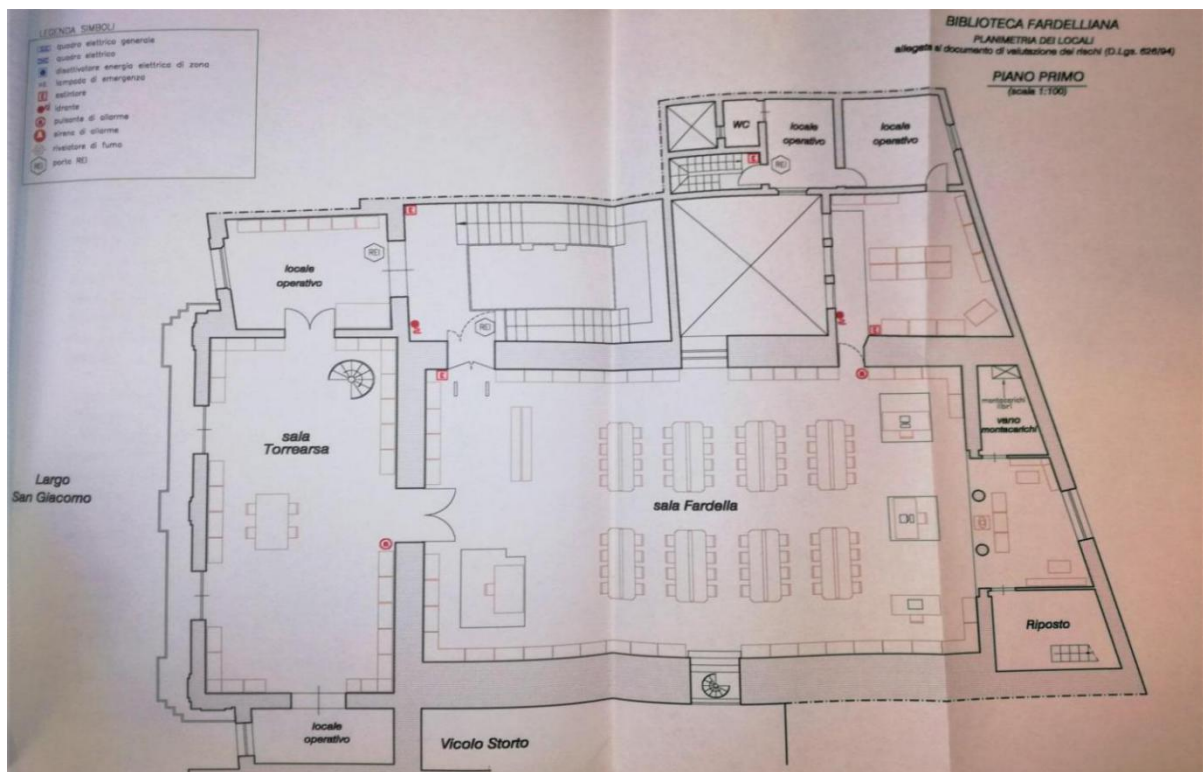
Planimetria Piano Primo della 'Biblioteca Fardelliana'
